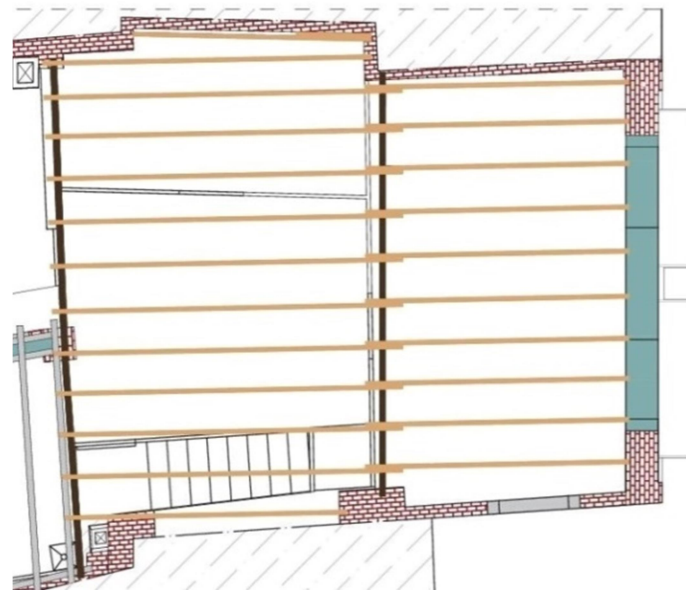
Planta estructura de tejado a dos aguas con acabado en teja árabe sobre faldón de cañizo
